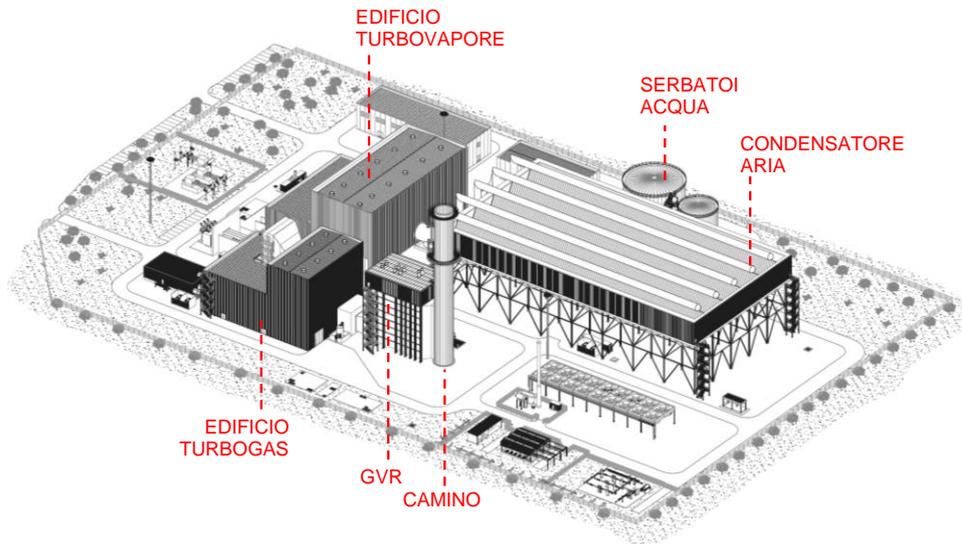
(2 di 2) Vista assometrica da Sud-Est – Stato di progetto
